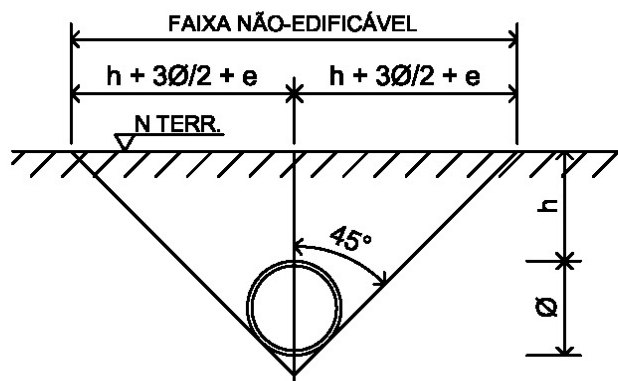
Faixa não-edificável gerada por canalizações pluviais de seção circular.
